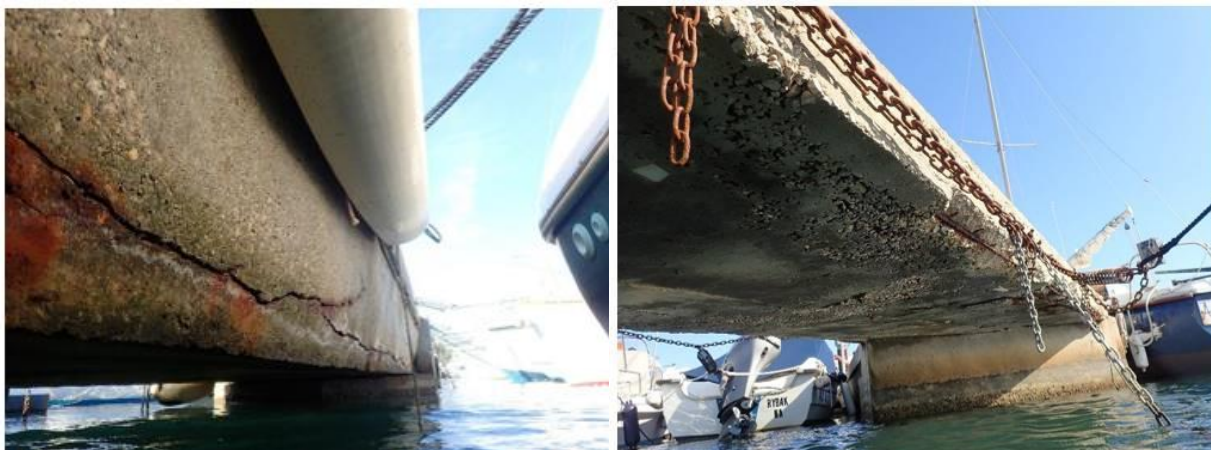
Fissures sur la poutre de couronnement et épaufrures avec acier apparent
